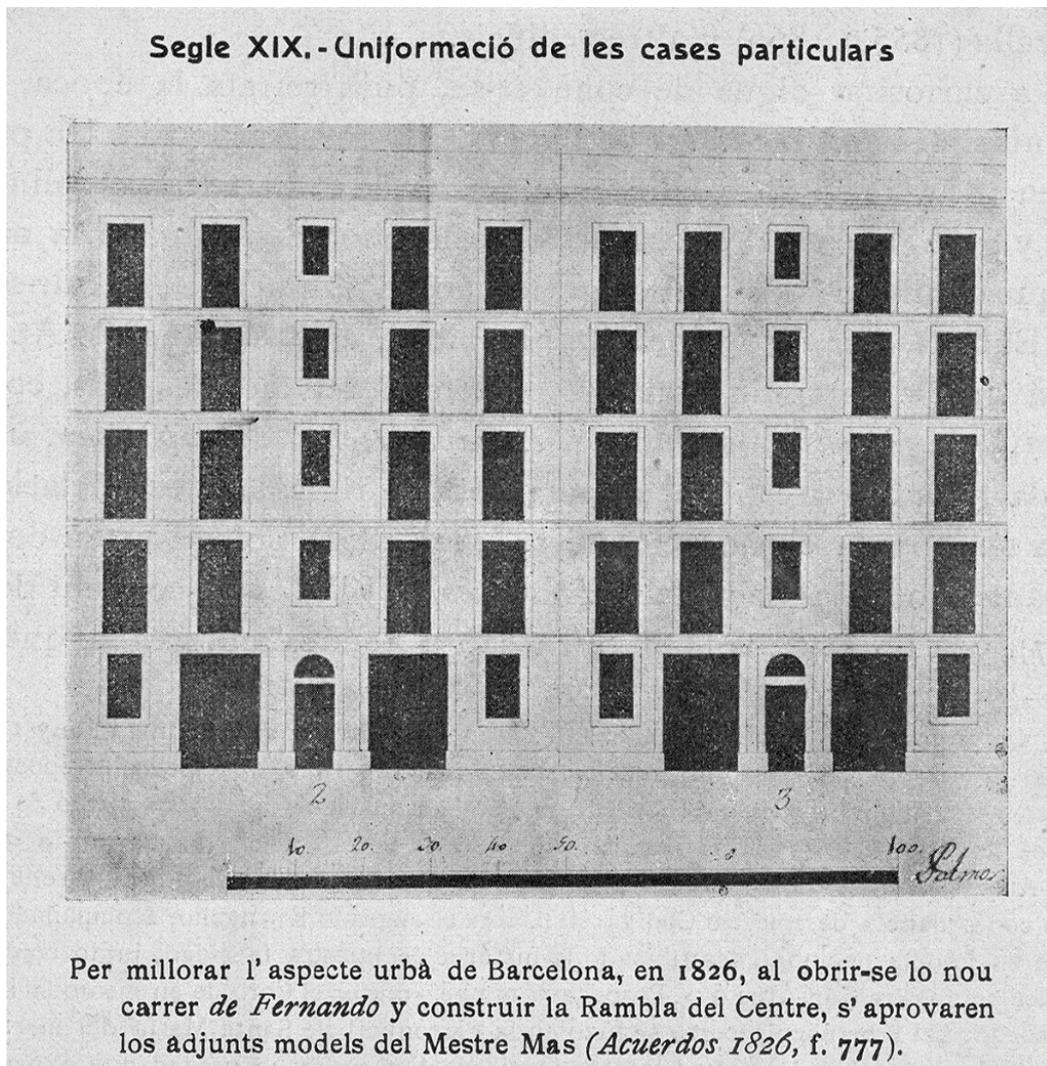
1826. Modelos de fachada para los nuevos edificios a construir en la calle Fernando, realizado por Josep Mas Vila. Fuente: Carreras Candi, 1916
